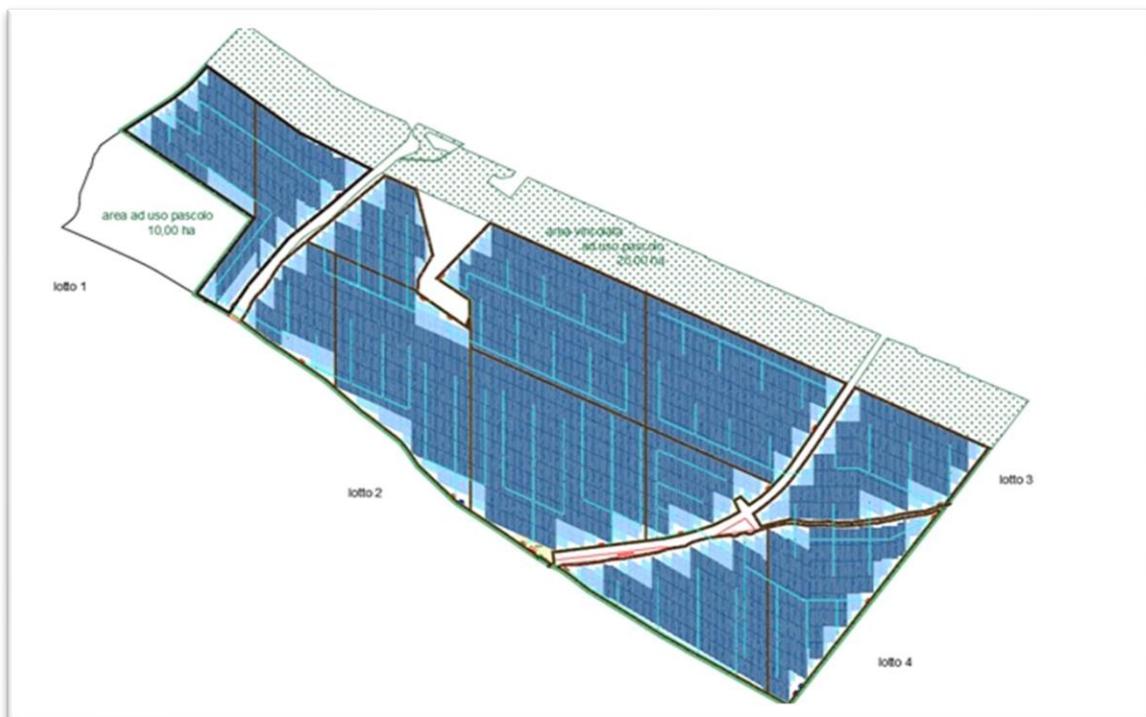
Layout di progetto con evidenza delle fasce di rispetto
